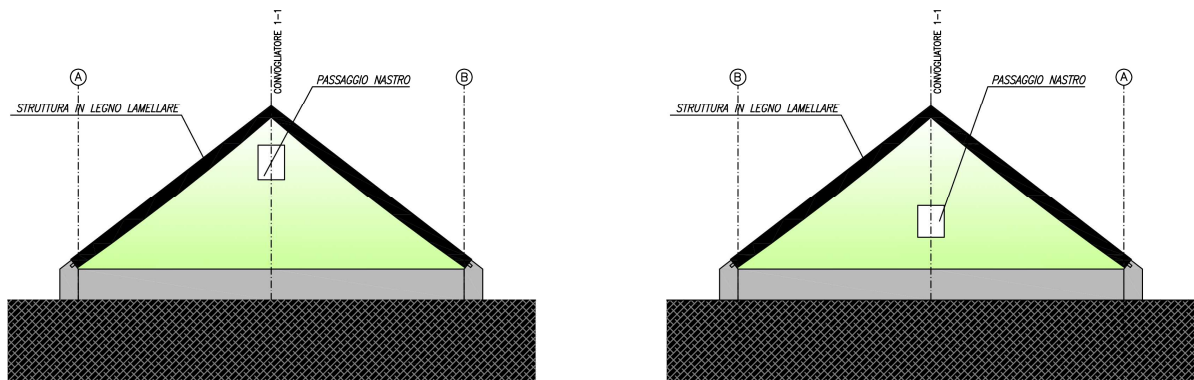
c Prospetti trasversali della copertura proposta
